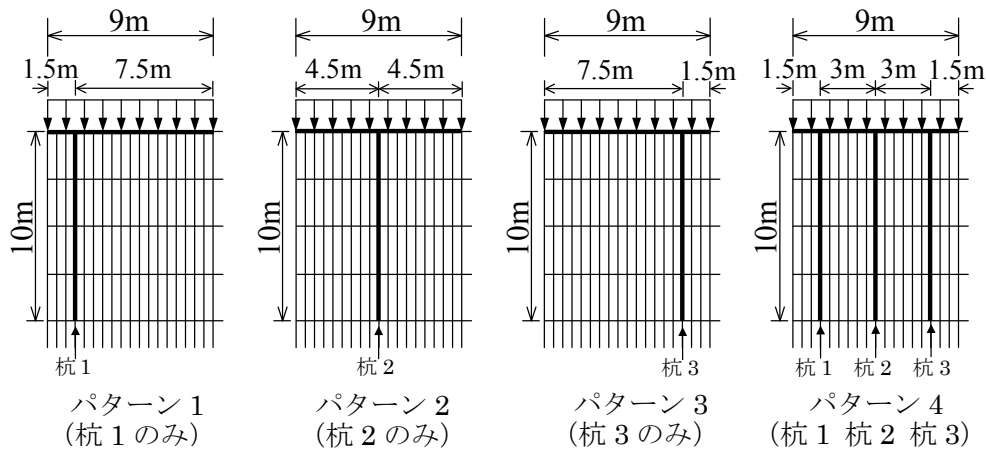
摩擦杭の設置位置の異なる基礎形式(半断面)
